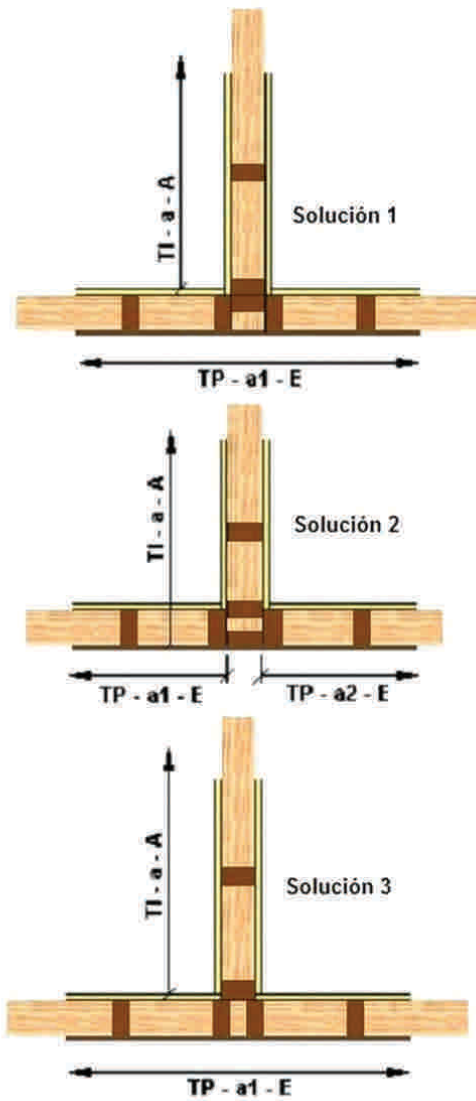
62: Vista en planta para el encuentro entre muros y tabiques unidos en "T".
